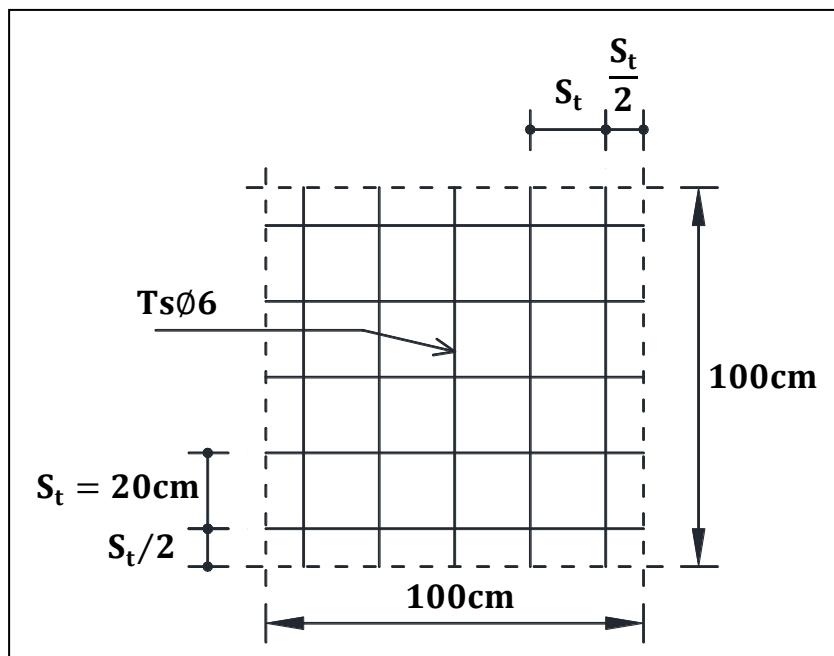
Ferrailage en treillis soudé de la dalle de compression.
